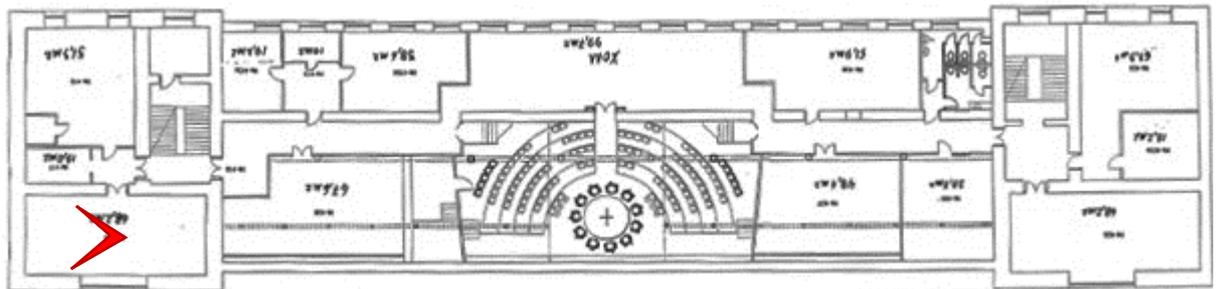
4 этаж. Помещение 11-Н(5-8).
